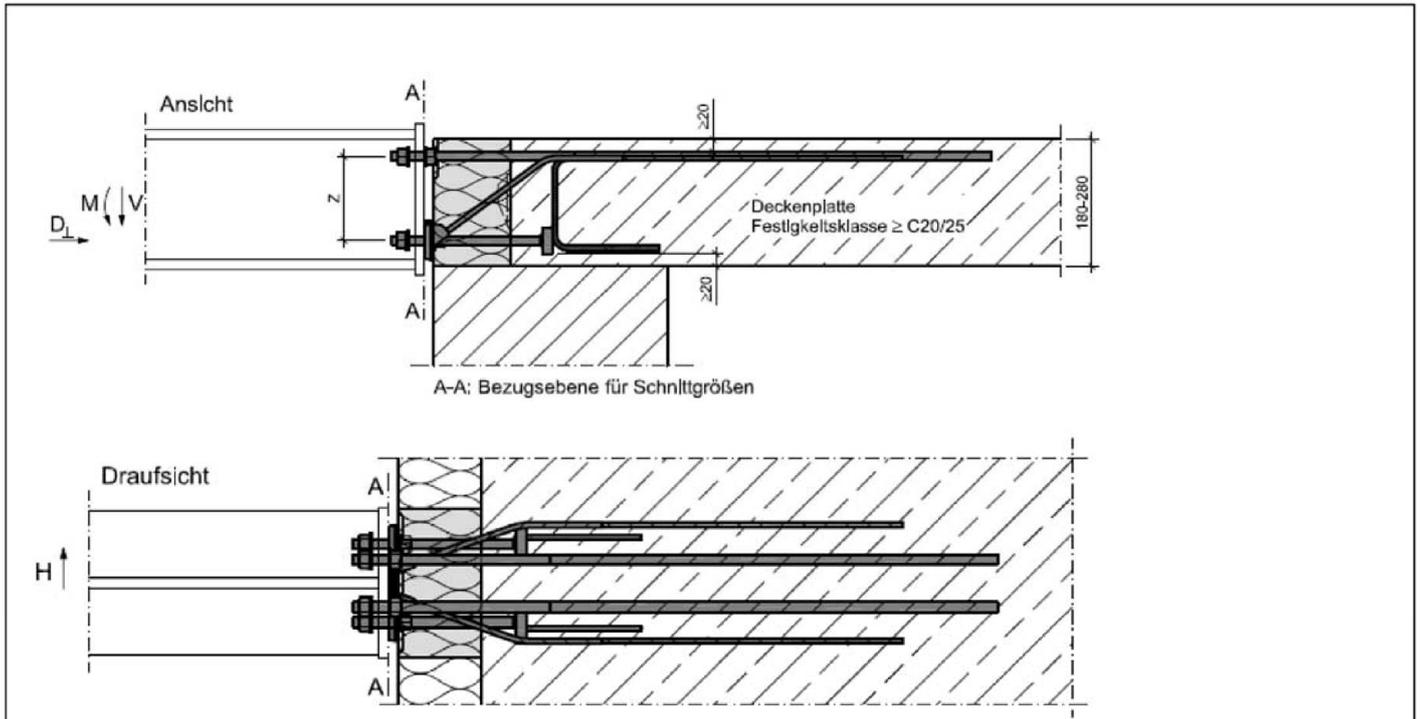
und 66: Schöck Isokorb® XT Typ SK-M1-V1, Schnittgrößendefinition
